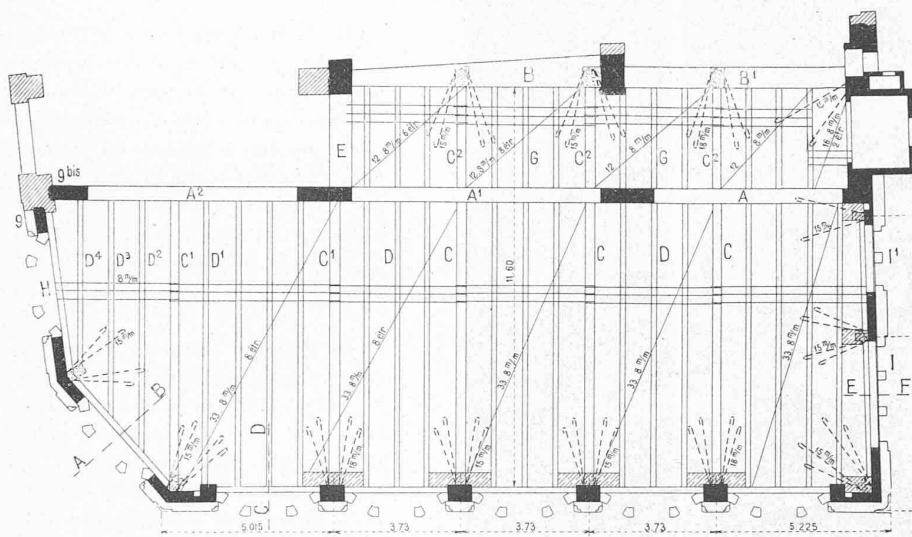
Plan du III^{ème} étage. - 1 : 200.
